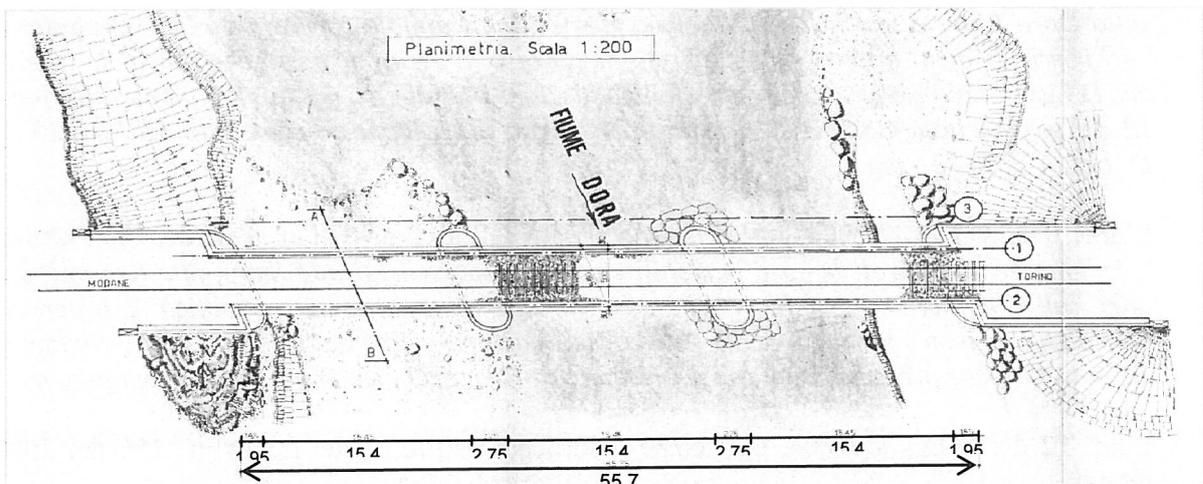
Planimetria estratta dall'elaborato "Ferrovie dello Stato - Direzione Comp.le Torino – Ufficio Lavori – Divisione 1° Sezione – 523/1/48 del Giugno 1980"
